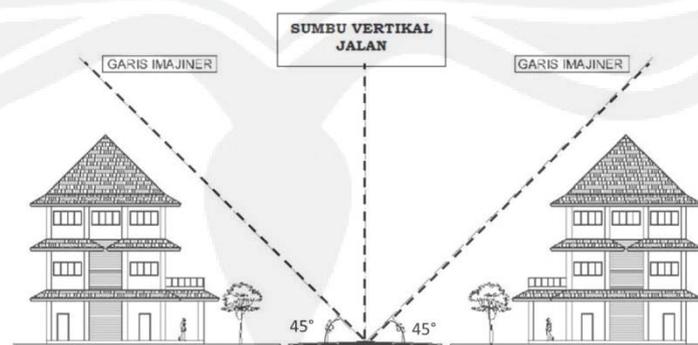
Contoh Bangunan Melibih 3 Lantai
